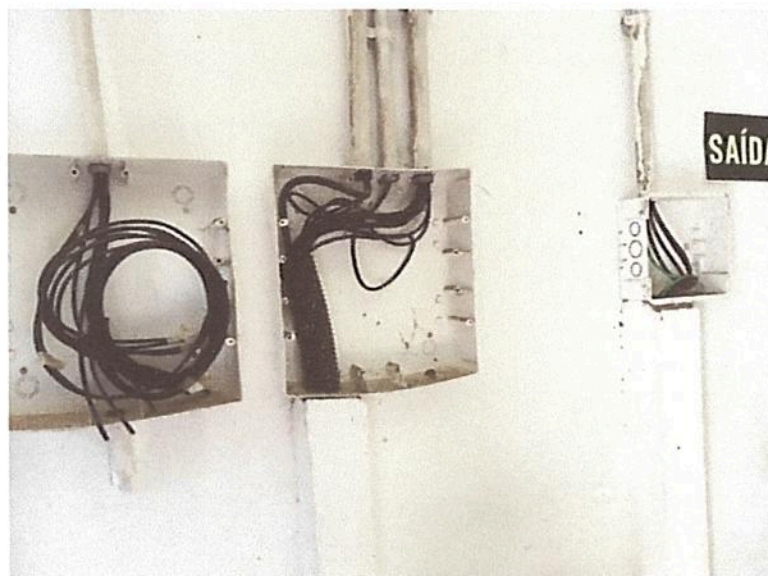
caixa de passagem da rede de dados instalado no hall de entrada
